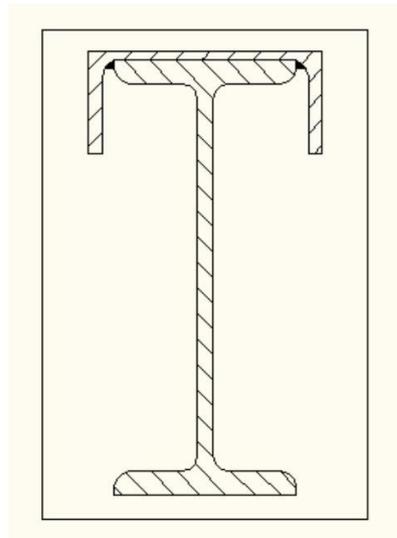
Disposición carril de rodadura UPN160 sobre la viga carril IPN300
